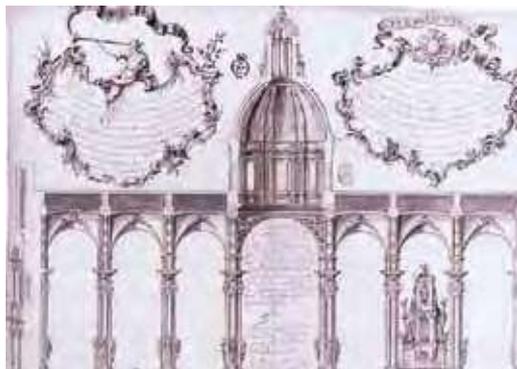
Sección longitudinal del proyecto de templo dedicado a San Miguel, presentado por Juan José Nadal en su solicitud de acceso a la Academia de San Fernando de Madrid en 1756. RABBAASF 1757. A-4440.
